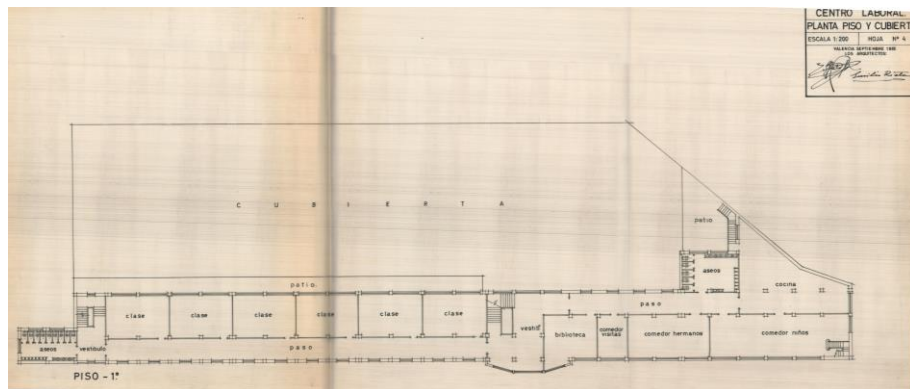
Planta piso y cubierta del Centro Laboral de La Salle
